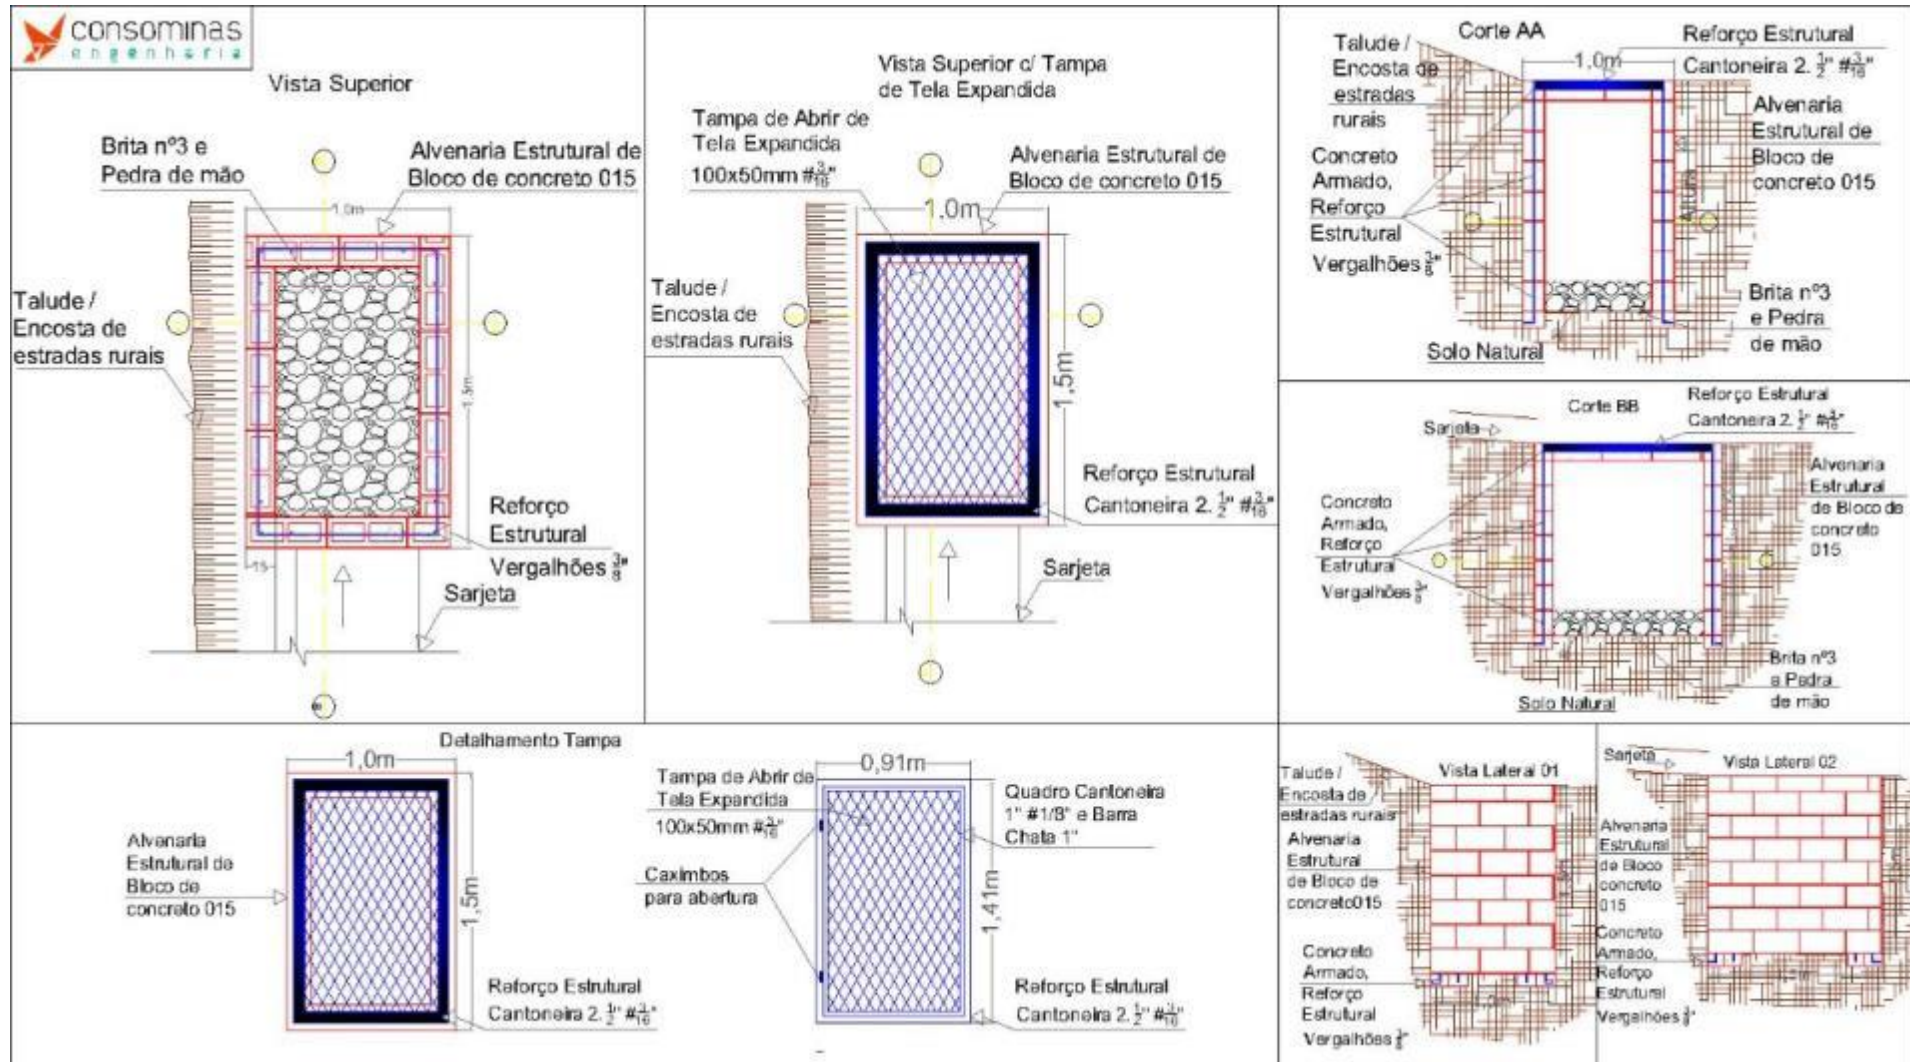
Planta e perfil de caixa de infiltração/dissipação em alvenaria estrutural.
